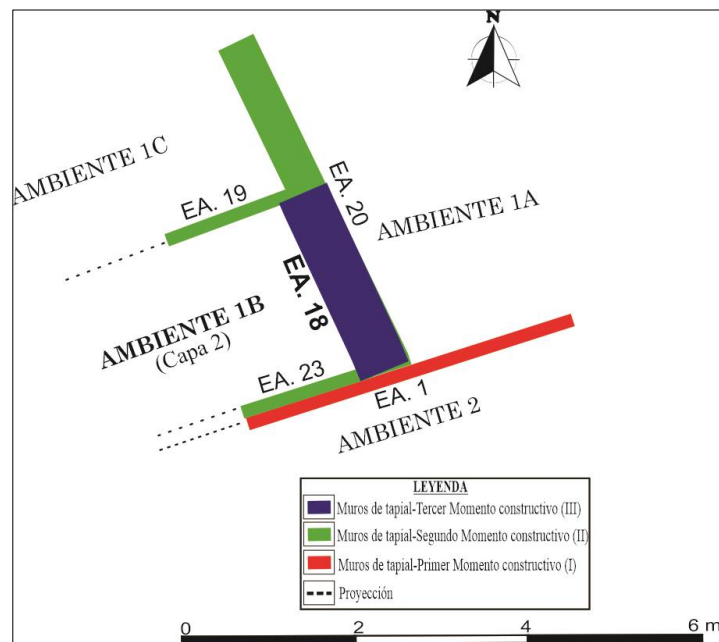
Planta arquitectónica del Ambiente 1B (A-1B). Tercer Momento Constructivo (III). Fuente: Elaboración propia.
